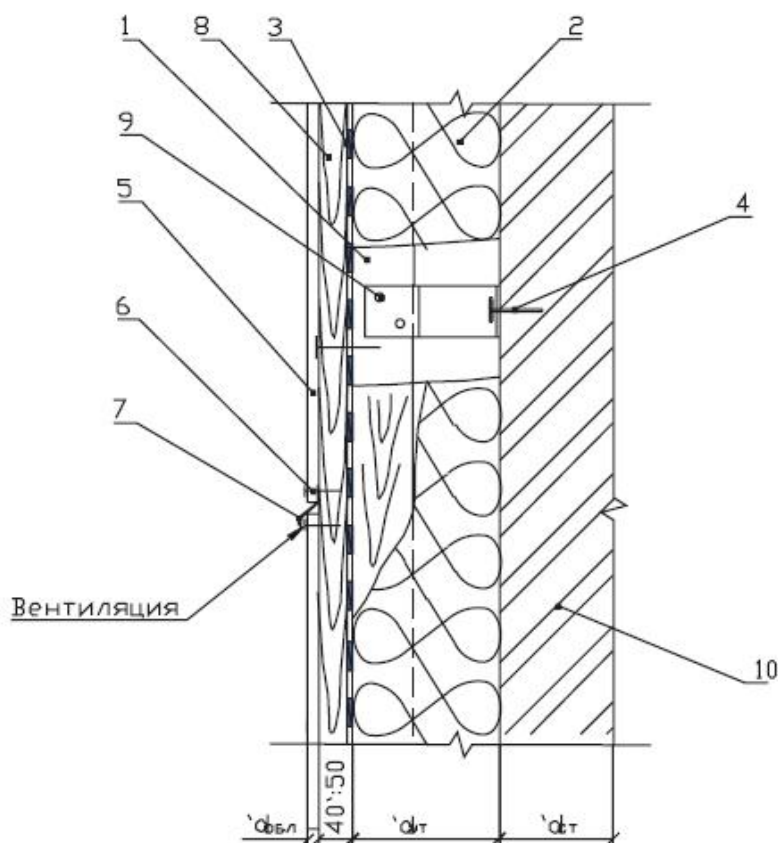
Узел примыкания к парапету стены с теплоизоляцией плитами марки "ТЕРМОВЕНТ" в конструкции вентилируемого фасада.
